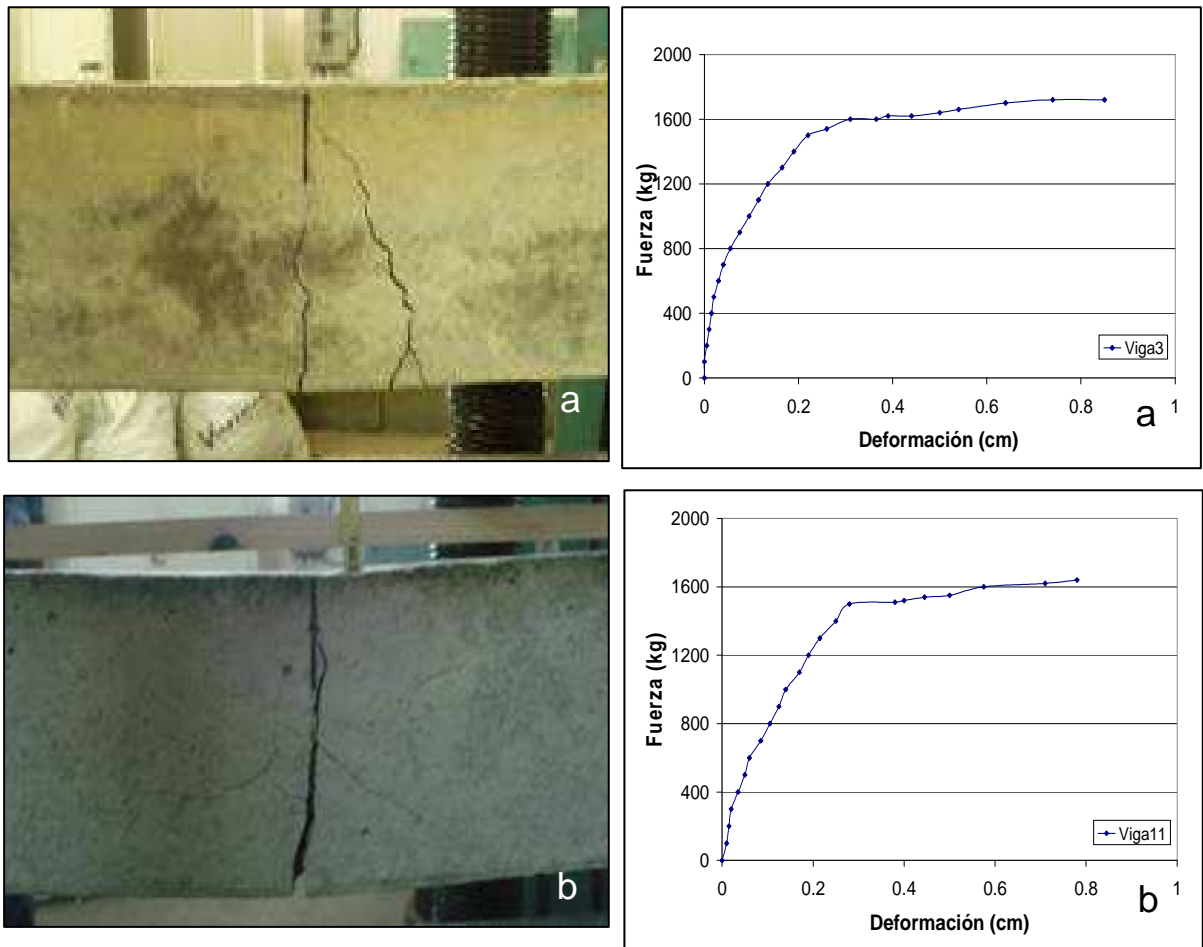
Falla por flexión en vigas reforzadas corroídas.
